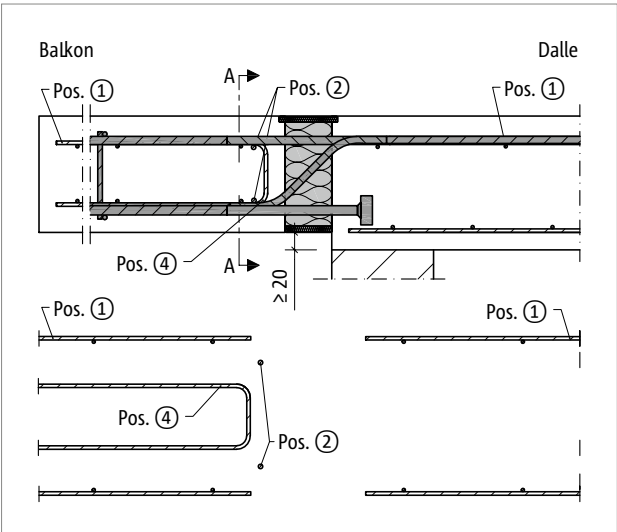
Schöck Isokorb® T type K-T-M13 : renforcement sur site pour support direct
